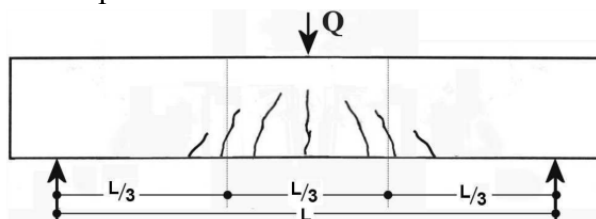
Faciès de fissuration initiale et intermédiaire par moment fléchissant d'une poutre en béton armé (Croston [84])
